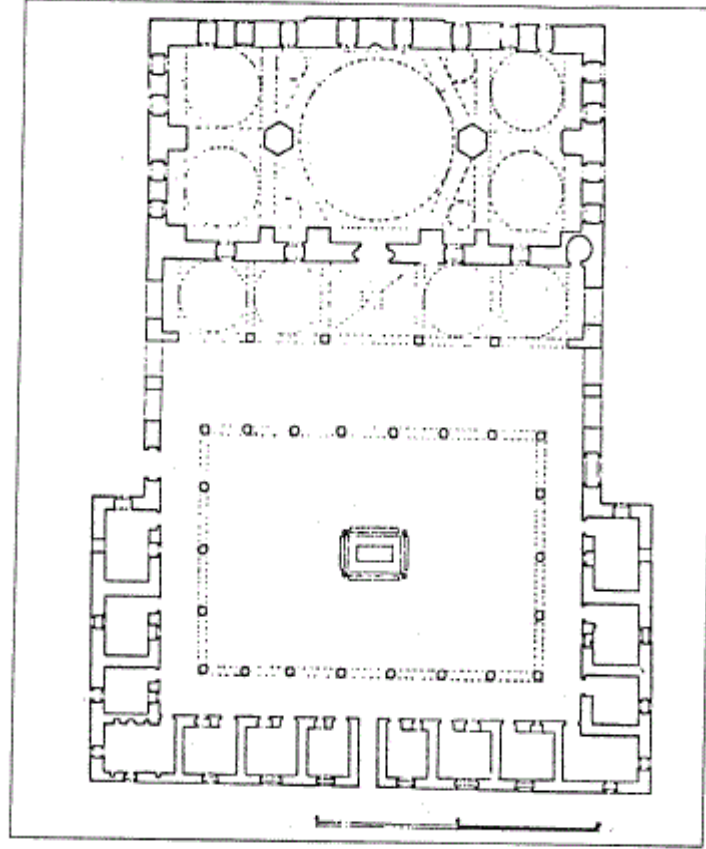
مسقط أفقي لمسجد قيرشنلو محمد باشا في شقودر بألبانيا (عن : كيل) .
